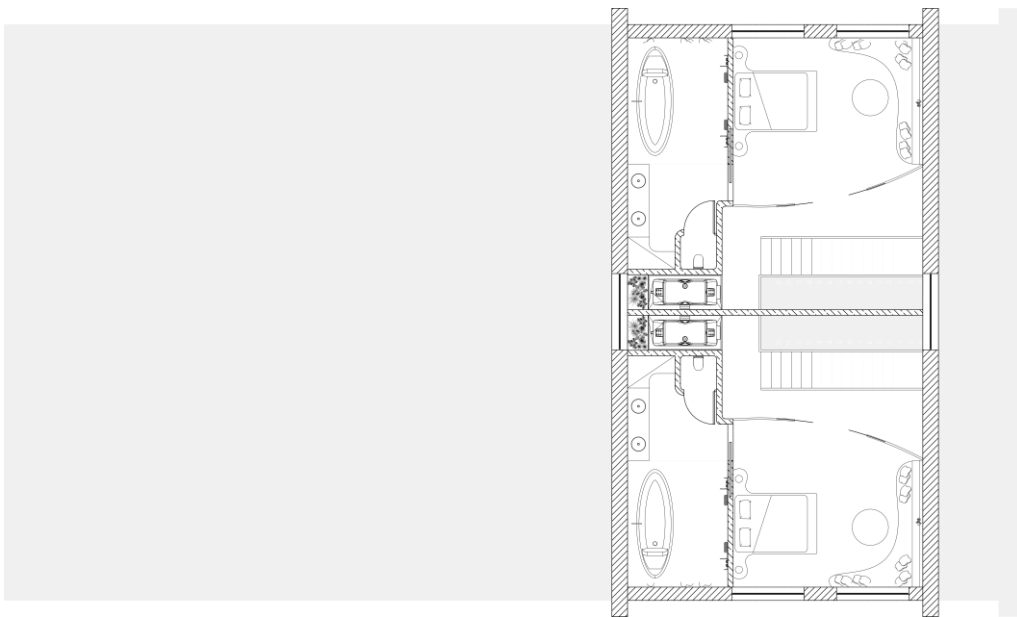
Planta proposta Piso 4 Fonte: Autor(es)
